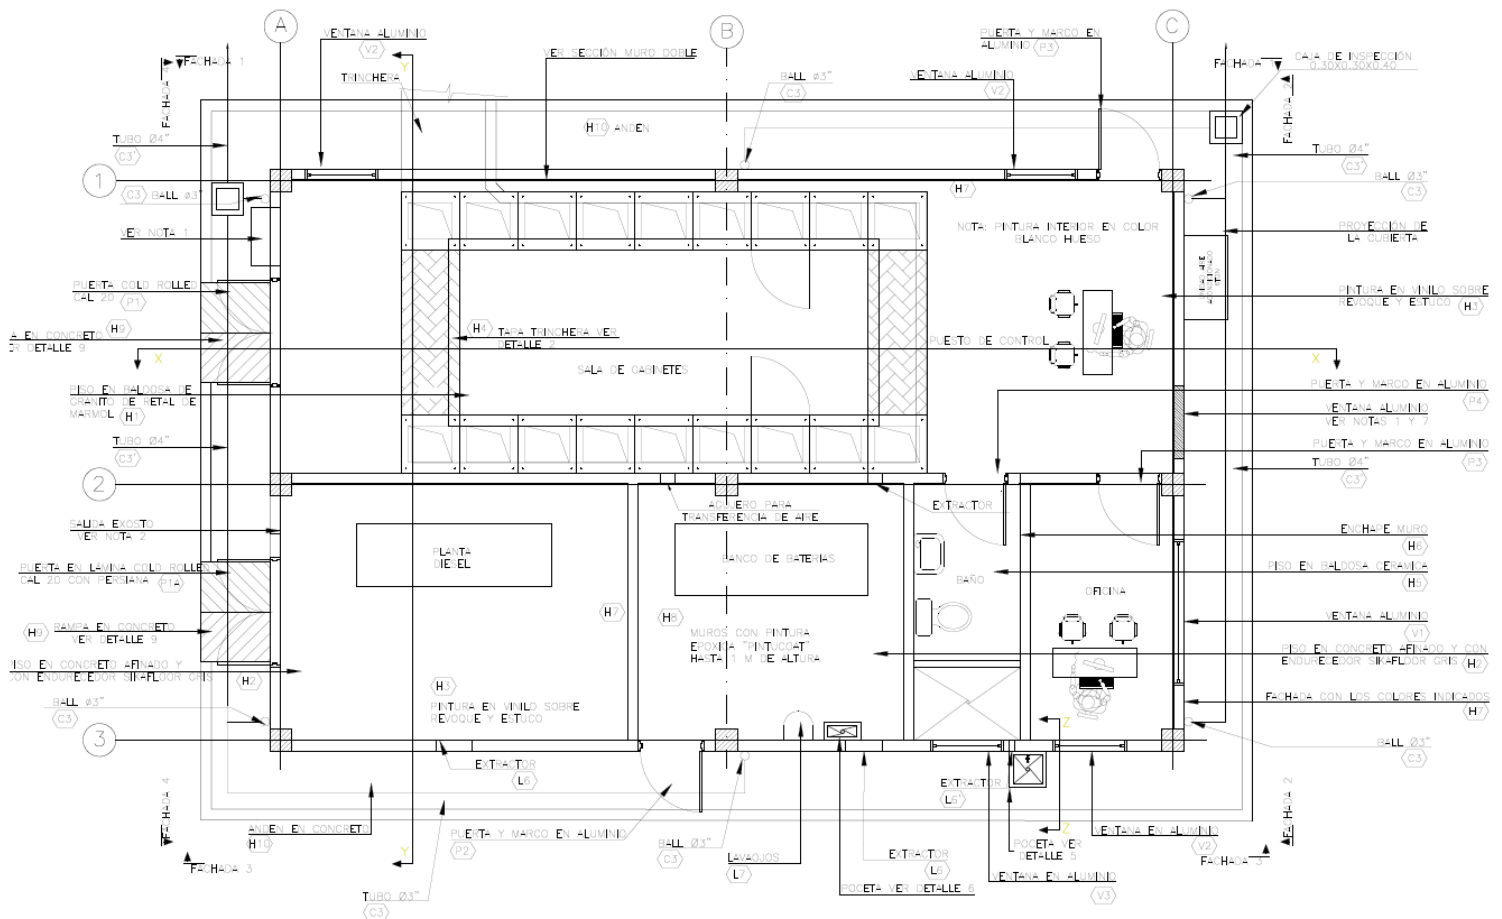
Dimensionamiento en planta edificio de control tipo.
